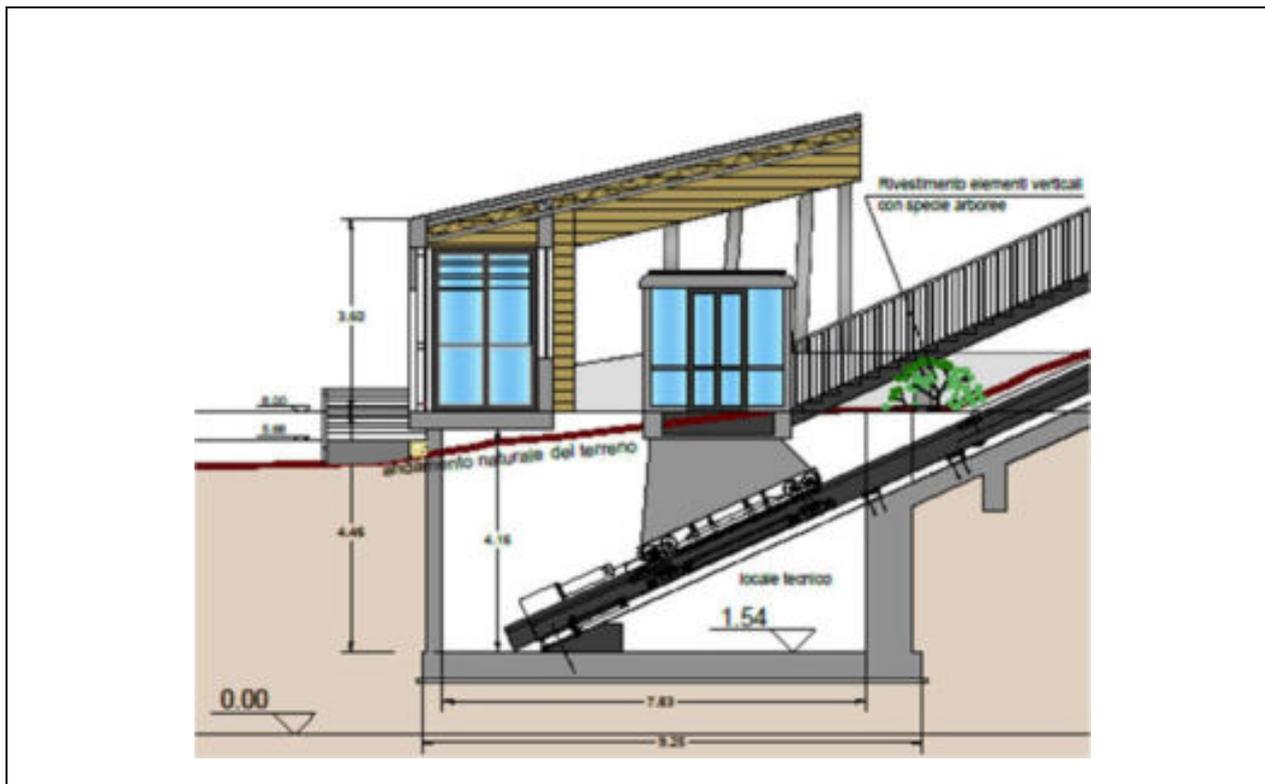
Sezione Stazione di Valle (Elaborato EG22)
